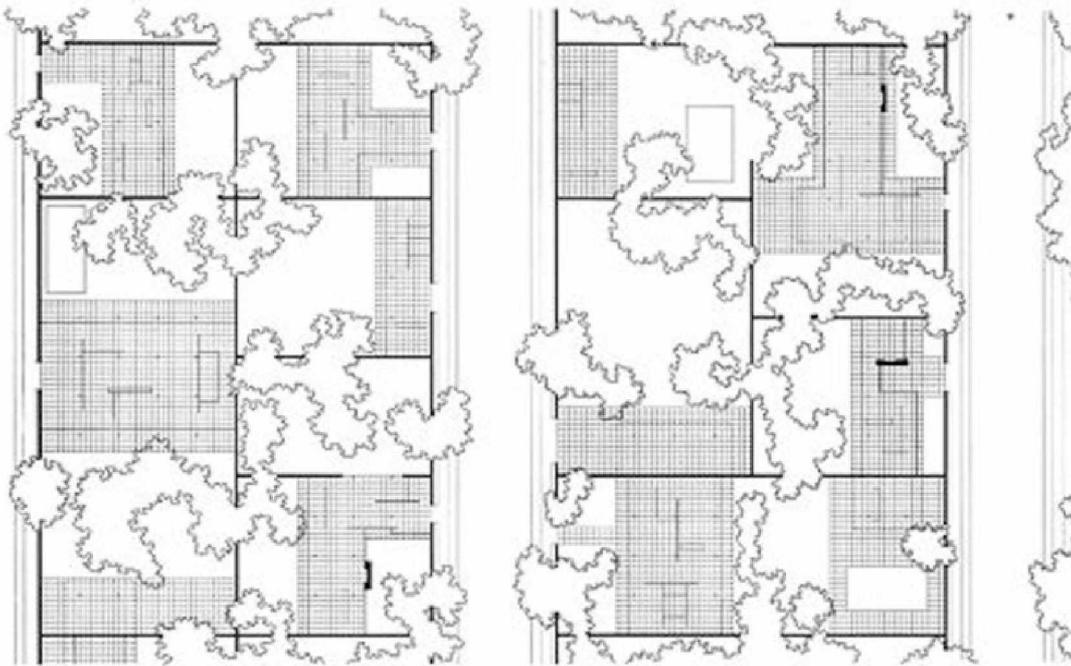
Planta de las viviendas patio de Mies van Der Rohe. Fuente: Smithson, A.(1974). How to recognize and read mat building: Mainstream architecture as it has developed towards the mat building. A.D. Septiembre 1974 p. 587.
